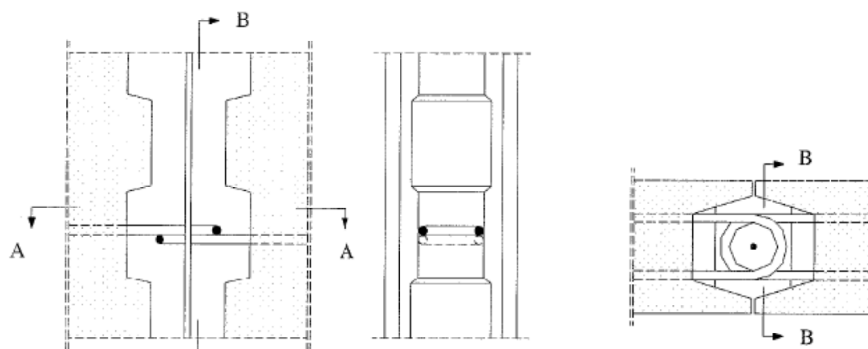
Ligação indentada típica entre painéis de paredes (Albarran, 2008)
